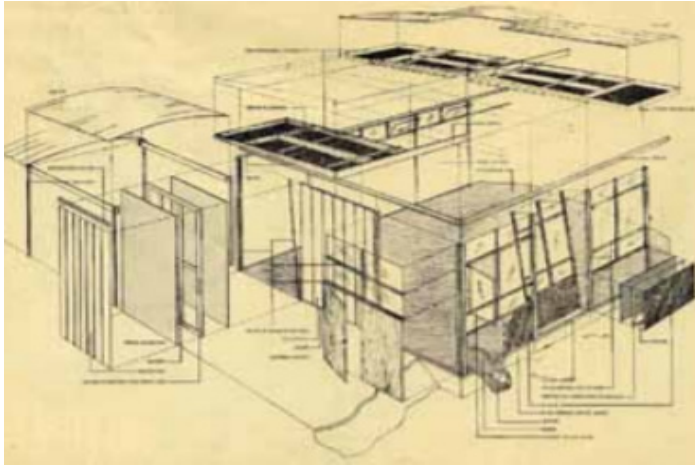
SISTEMA SIMPLEX Empresa: Empresa Constructora J. Siña Traverso + Arquitecto Oscar Zaccarelli
